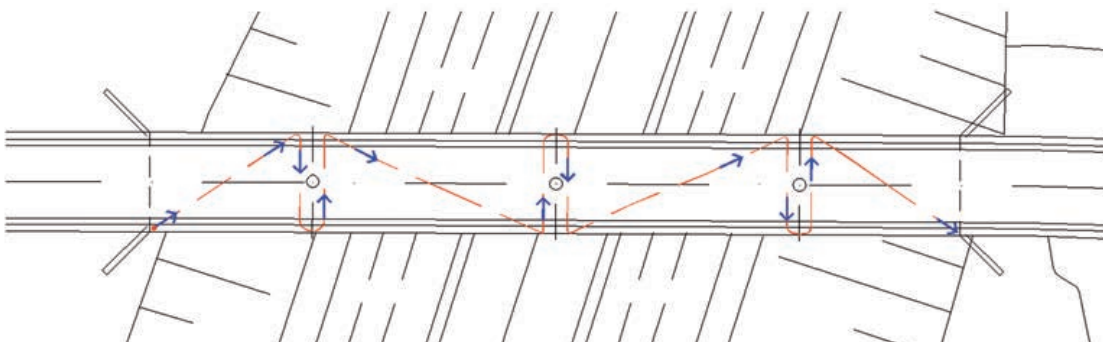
INSPECCIÓN EN «ZIG-ZAG» INFERIOR.
